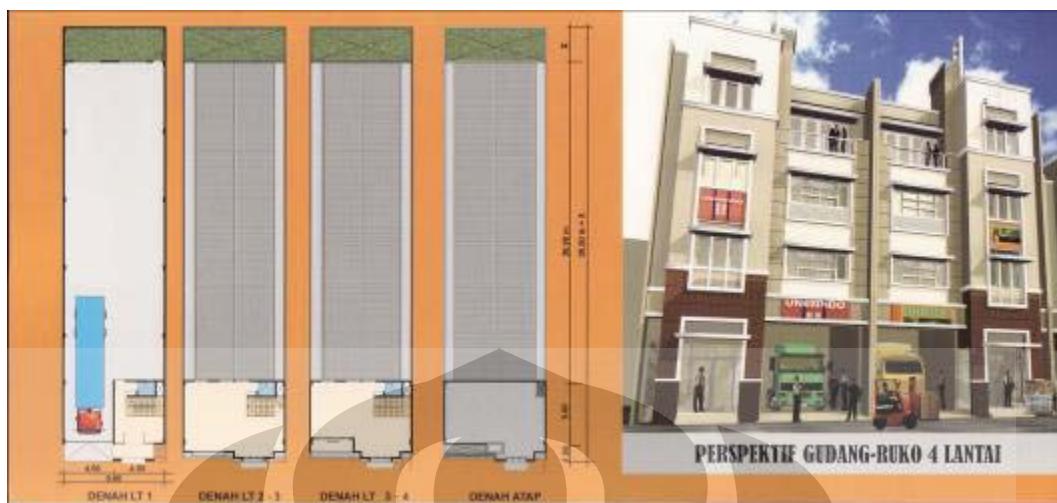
Site Plan Pergudangan Duta Indah Kapuk
